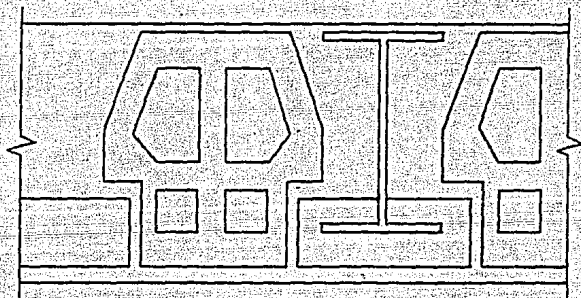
VIGUETA DE PISO CON PIEZAS DE CONCRETO
